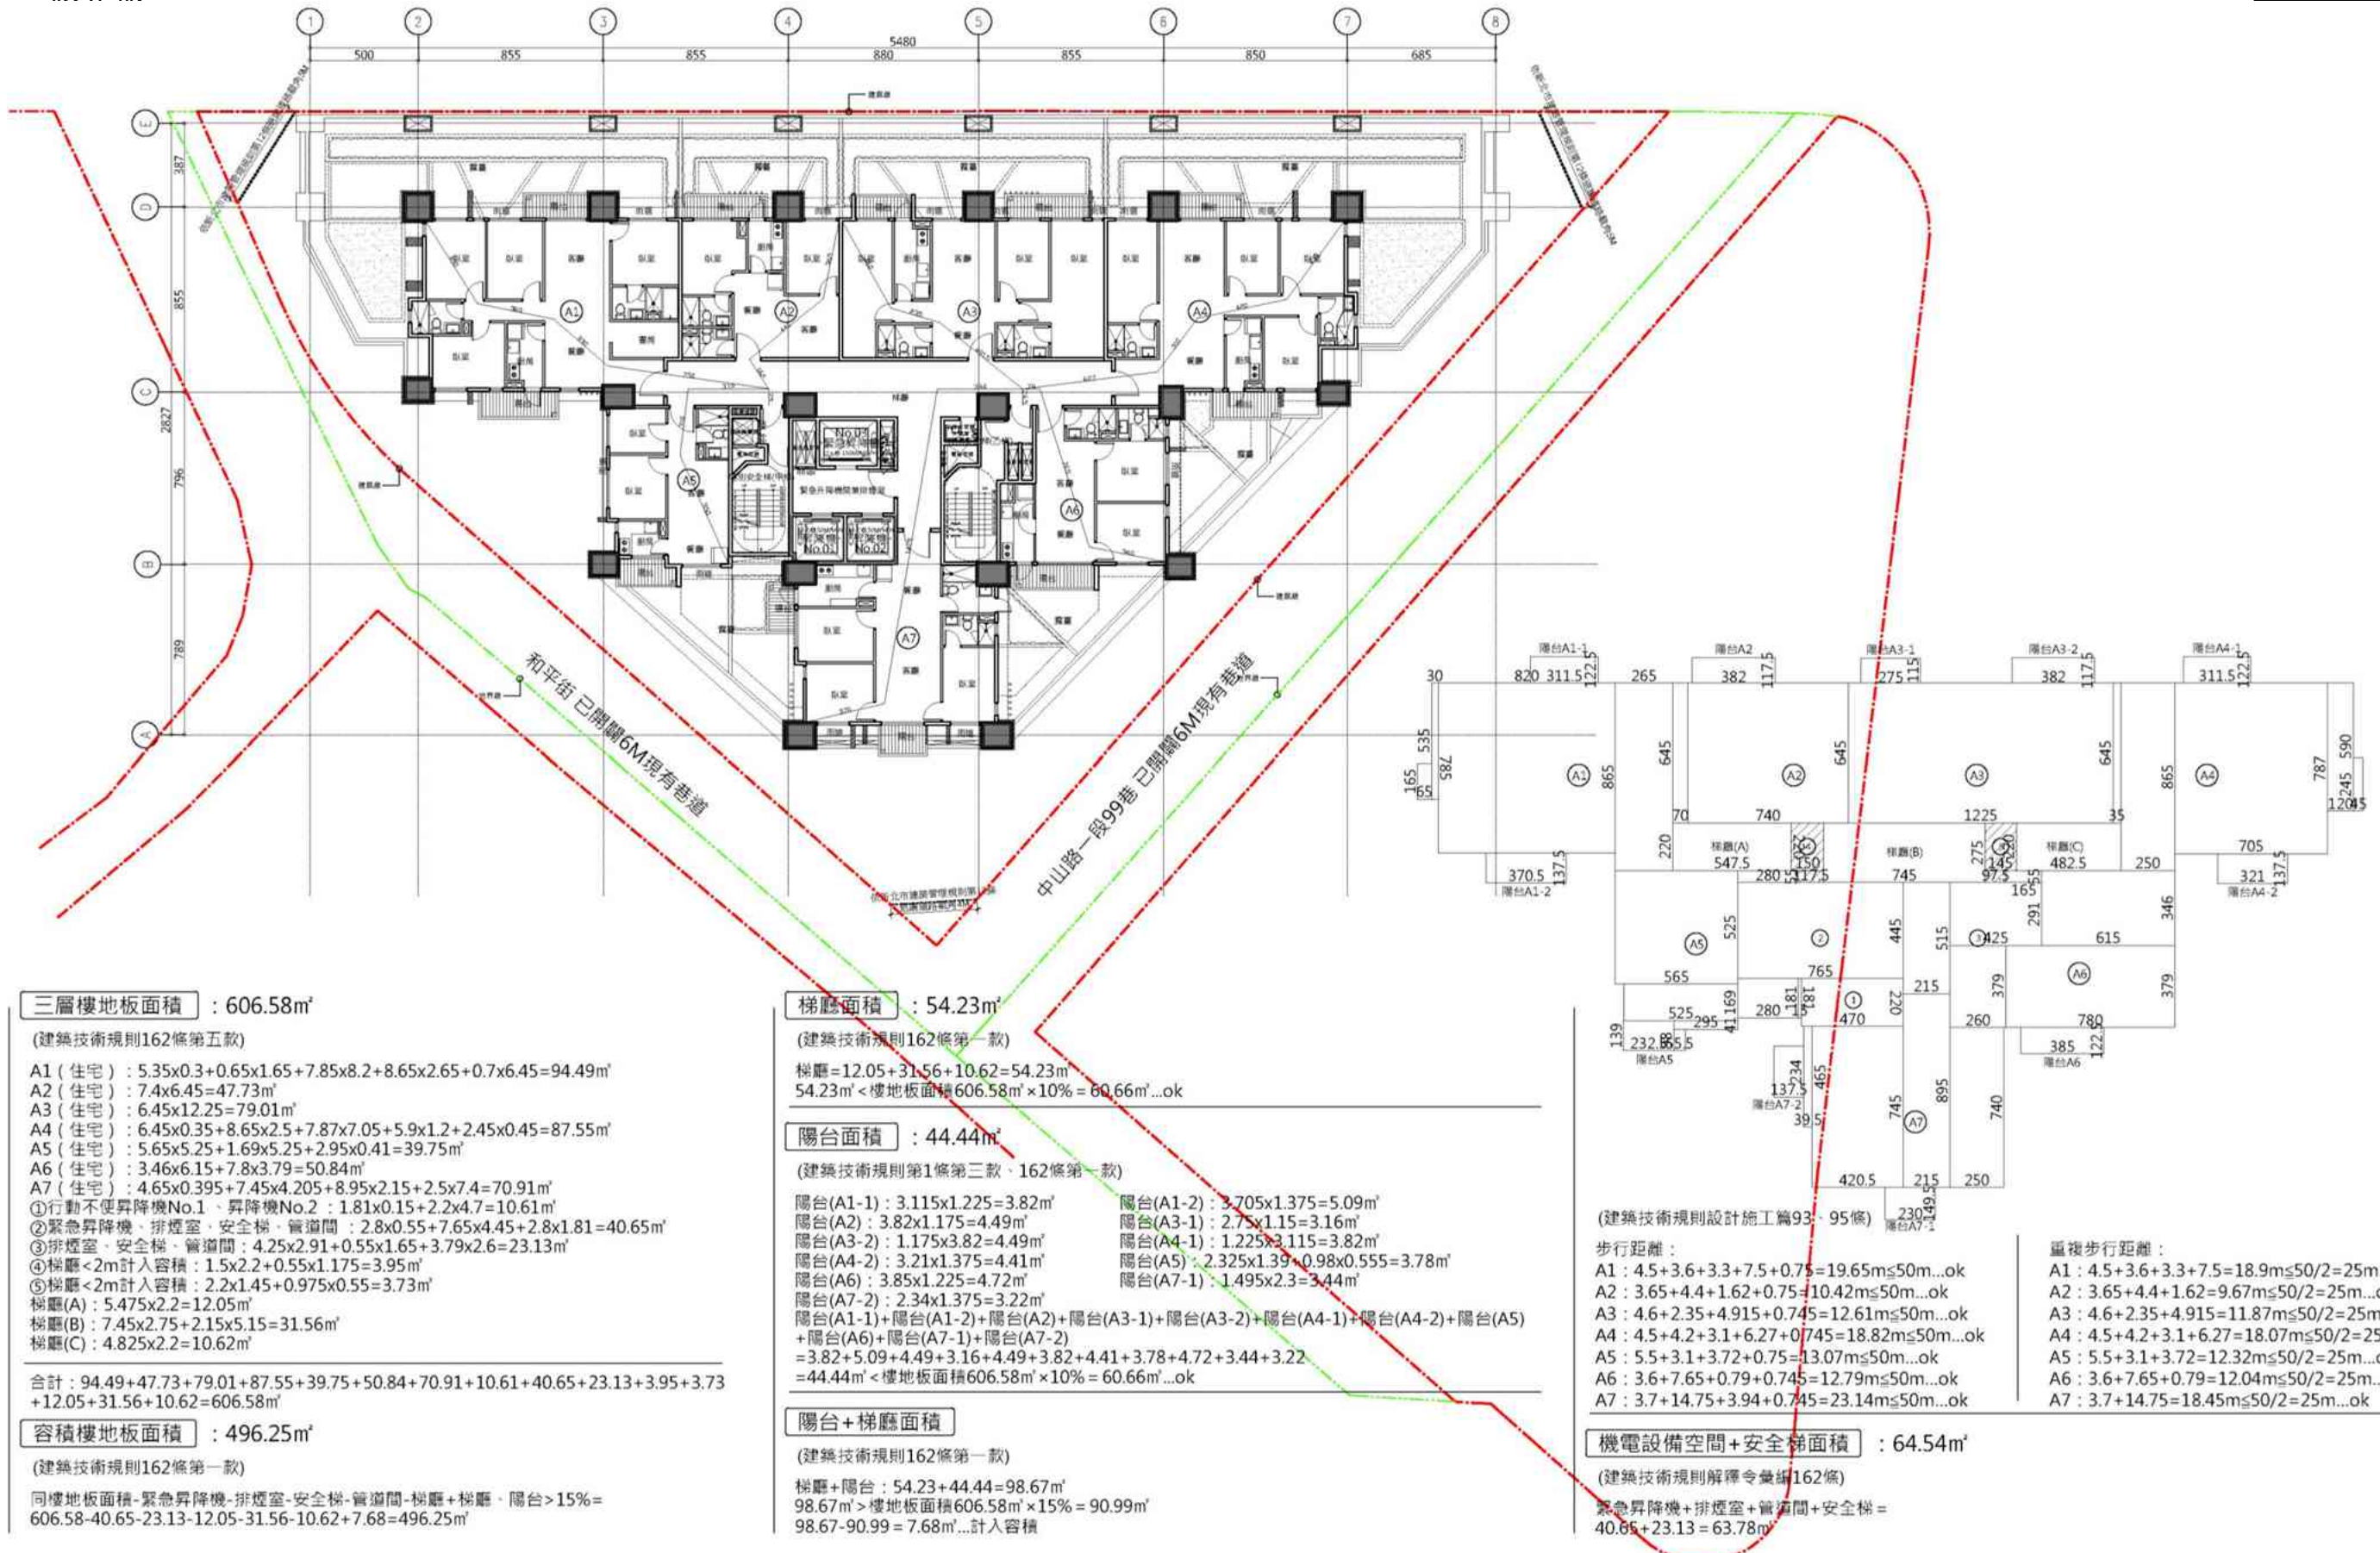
2F 平面圖 ; SCALE A3=1/300
